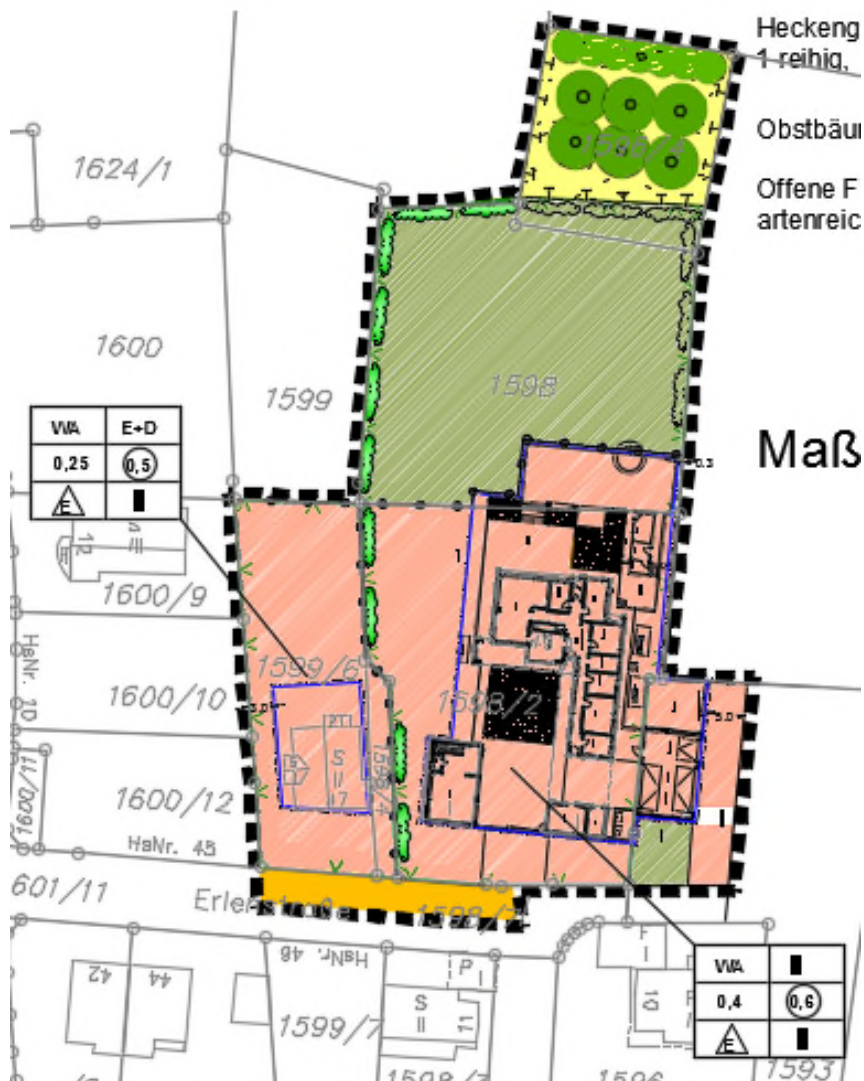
Entwurf der 3. Änderung Bebauungsplan „Birkenstraße Nord“ unmaßstäblich
